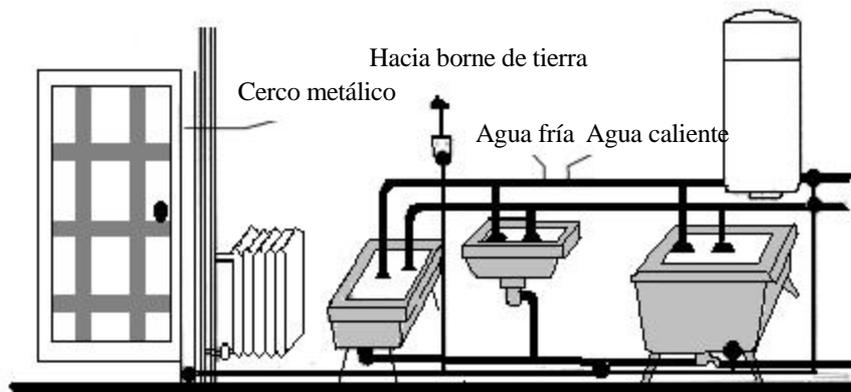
Conexión equipotencial de las masas metálicas de la instalación mediante conductores de protección
